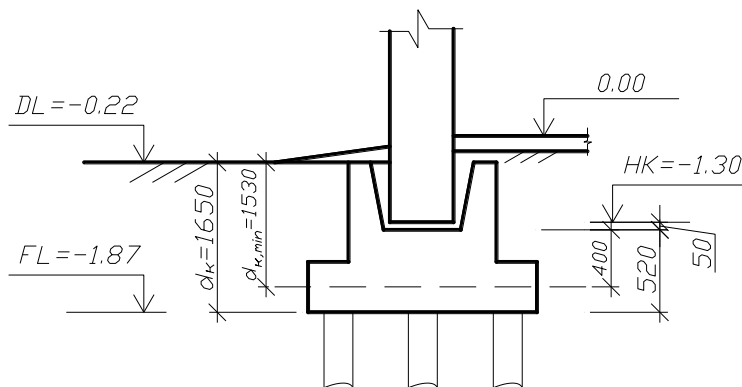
Схема к определению конструктивной глубины заложения подошвы фундамента
